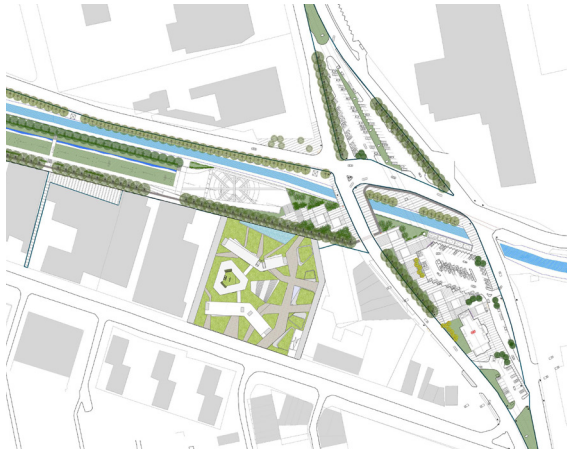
Planta de emplazamiento (sin escala).
